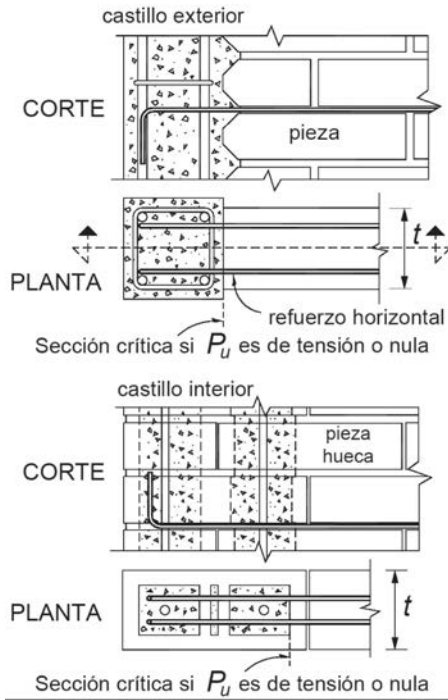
REFUERZO HORIZONTAL EN JUNTAS DE MORTERO.
